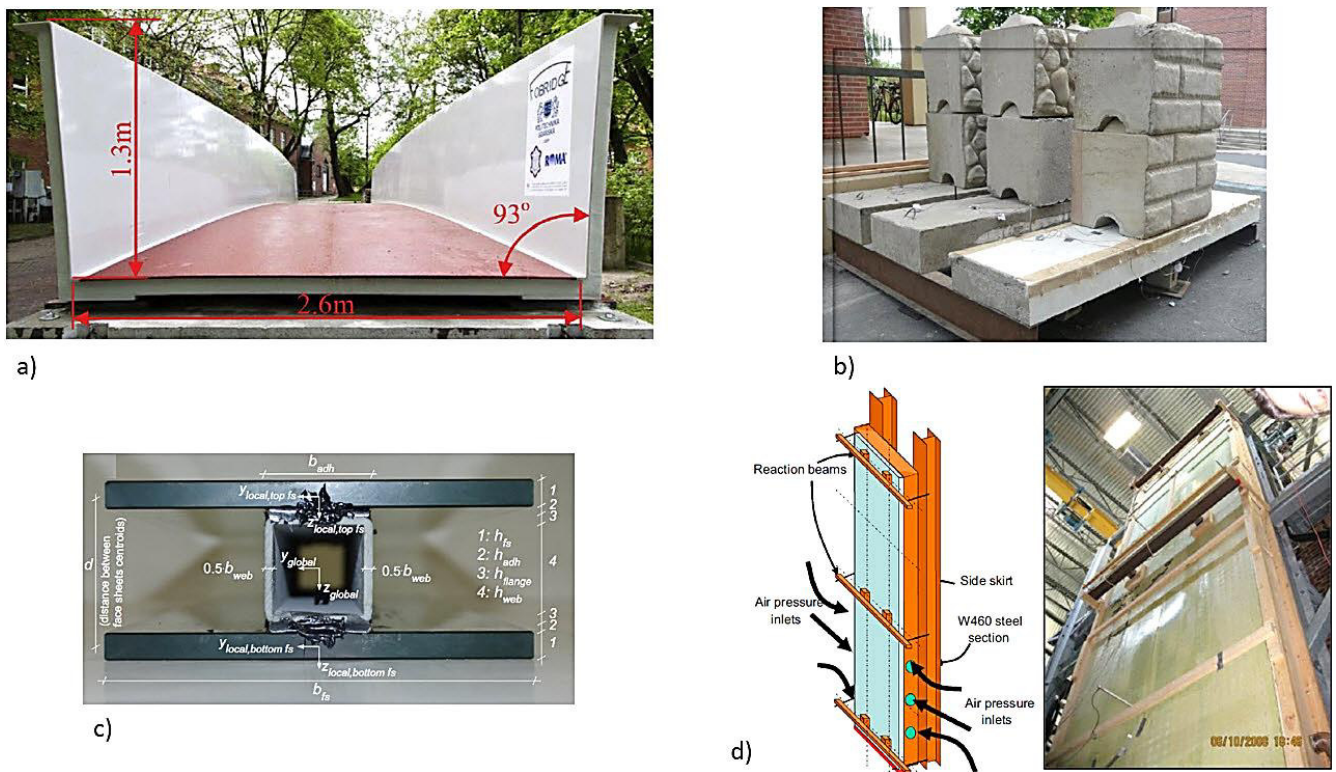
Quelques application des panneaux sandwichs dans le génie civil : a) Passerelle piétonne [9]. b) Planchers et toitures [1]. c) Mur-rideau [10]. Panneau de façade [11].
